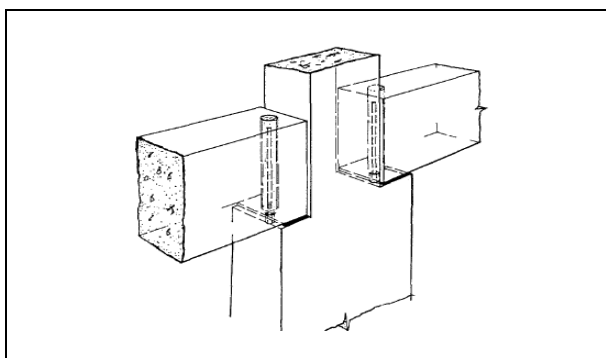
Vigas assentes diretamente num pilar contínuo (Elliott, 1996)
